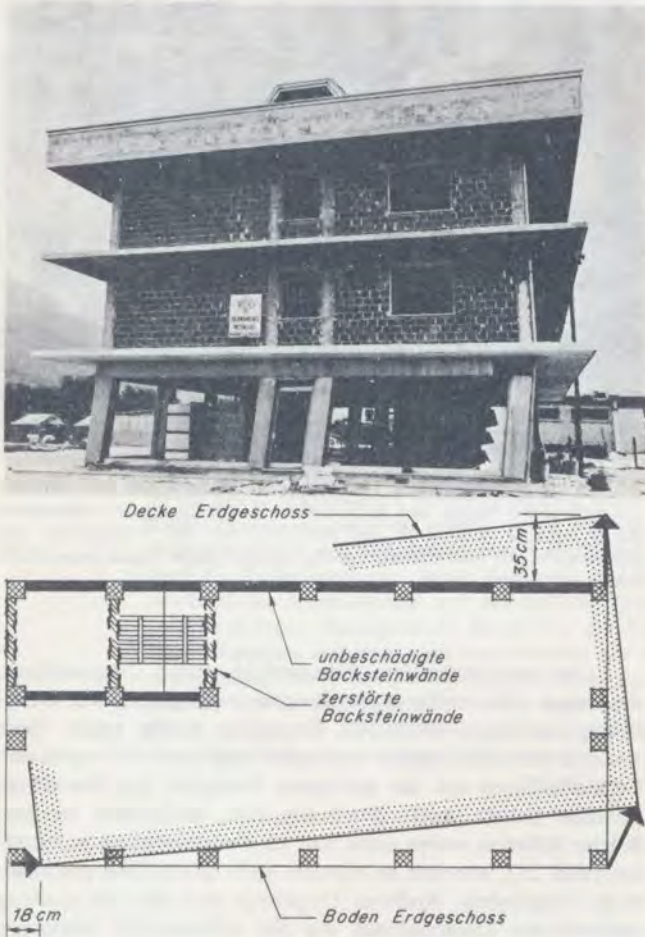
Wohnhaus mit Verkaufslokal bei Artegna. Stahlbetonskelettbau mit Backsteinfüllwänden in den Obergeschossen, im vorne offenen Erdgeschoss ist nur die hintere Längswand und das Treppenhaus ausgefacht. Die Drehbewegung des Gebäudes wurde durch die versteifende Wirkung der Treppenhauswände verursacht
